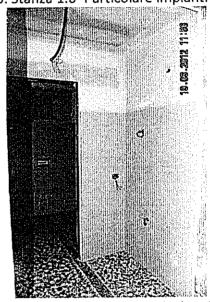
Stanza 1.7- Bagno, Particolare interno con impianti posati
